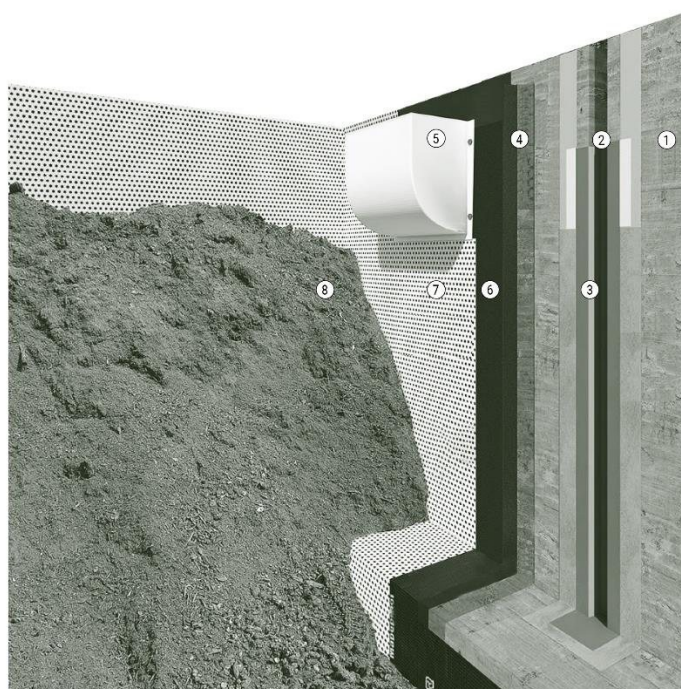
Schemă posibilă pentru impermeabilizare construcții. 1 - perete de subsol – din beton armat, dimensionat prin calcul structural; 2 - rost structural între două tronsoane ale clădirii; 3 - elemente de etanșare a rostului cu profil metalic și materiale elastice, conform unor sisteme agrementate; 4 – hidroizolație; 5 - trecere prin peretele de subsol – curte prefabricată de lumină, elemente de instalații – perimetral acestora se va realiza o etanșare corespunzătoare; 6 - termoizolație din materiale rezistente în mediu umed, protejată contra umidității prin metode specifice; 7 – barieră împotriva rădăcinilor; 8 - umplutură de pământ.
